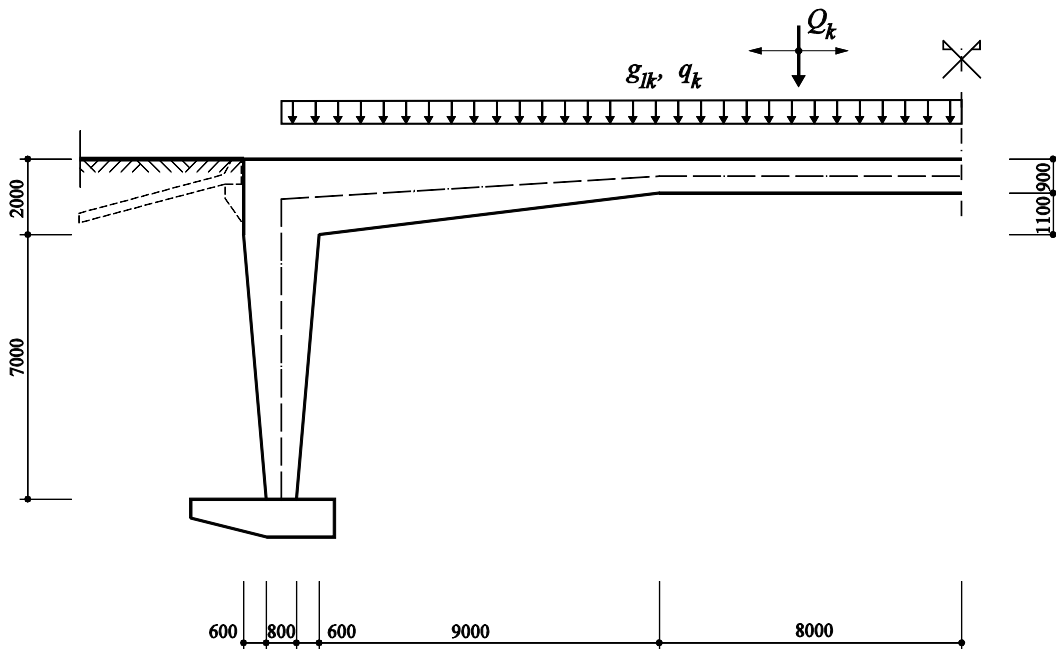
Rahmenbrücke – Geometrie und Belastung; Abmessungen in mm.
